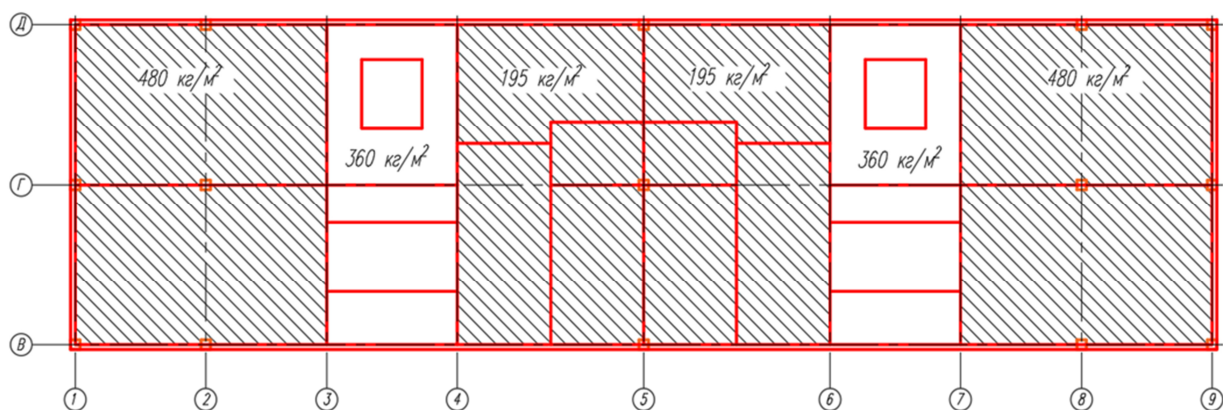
Схема приложения полезных нагрузок на перекрытие первого этажа, кг/м²
